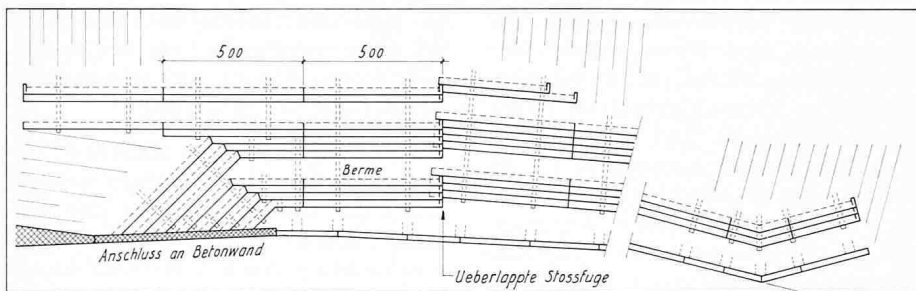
Grundriss der ausgeführten «dabau»-Stützmauer
